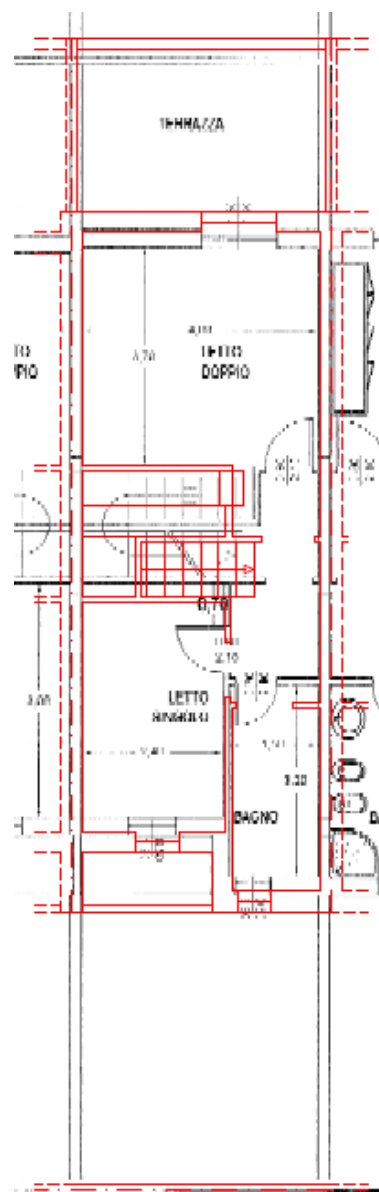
Sovrapposizione progetto-rilievo. Piano S1, fuori scala
